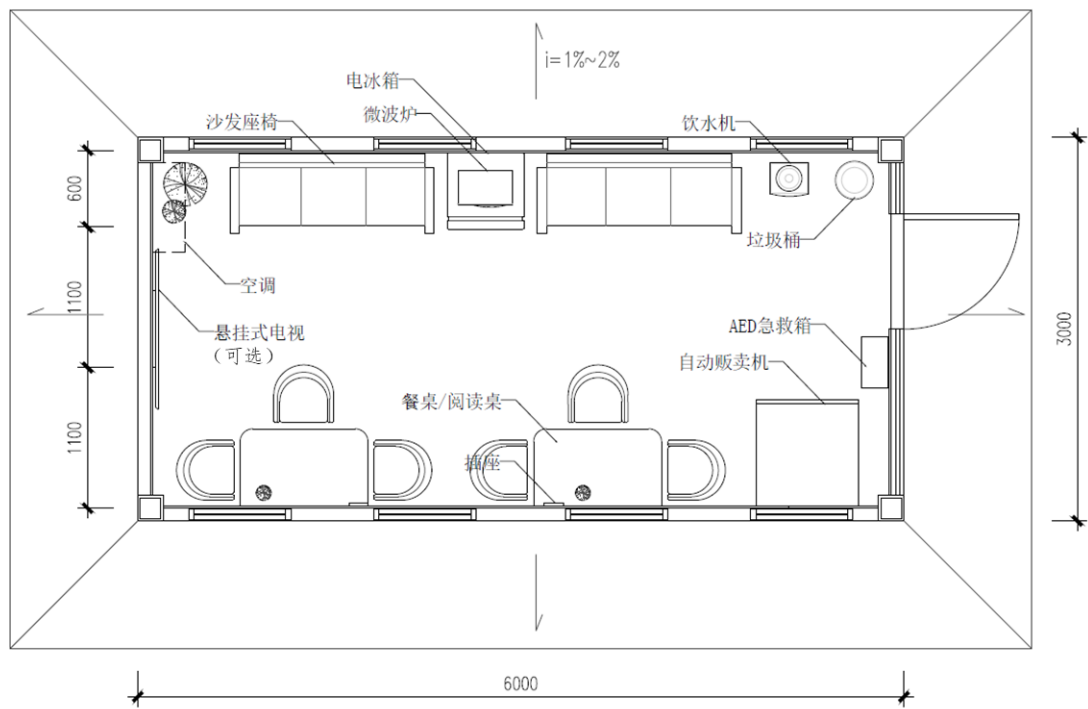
飞行区共享休息区基本单元平面示意图（单位：mm）
